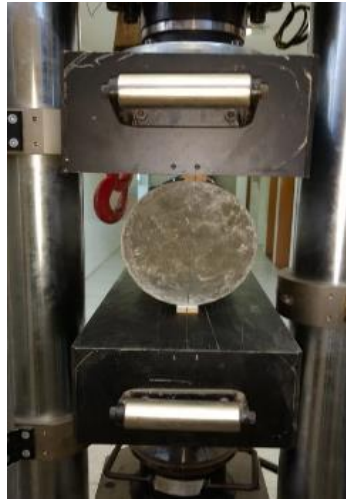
Ensaio de tração por compressão diametral do concreto.
